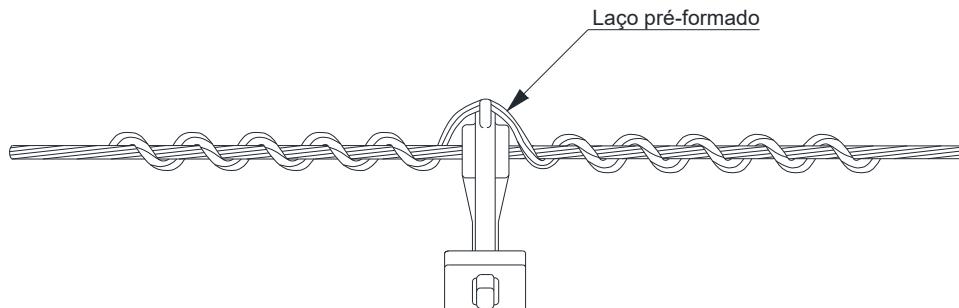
Amarrações e ligações – Amarração do espaçador monofásico, vertical e losangular em cordoalha – Laço pré-formado
